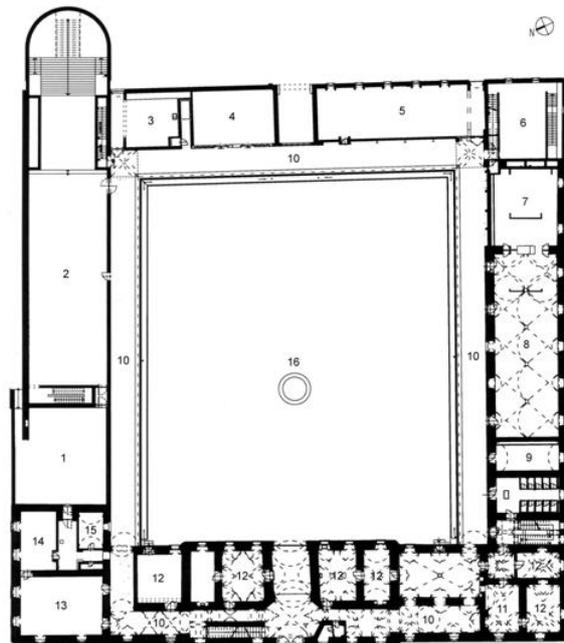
Planta 1º pavimento. Fonte: Atelier Soukup.
